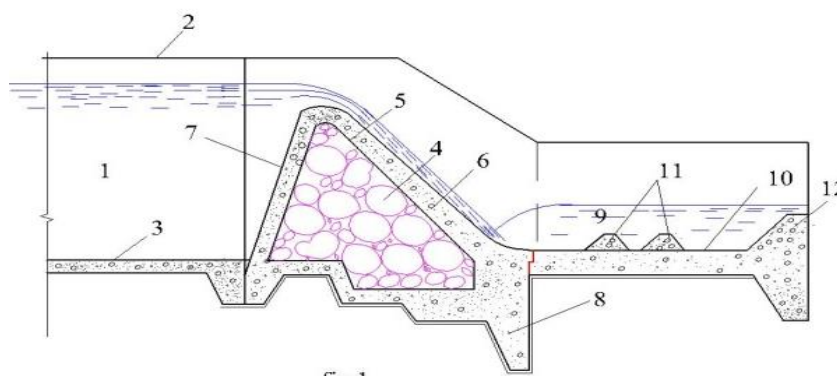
Поперечный разрез автоматической водосливной плотины сооружения: Подводящий канал-1, направляющая стенка – 2, понур-3, речные камни-4, водосливной части-5, железобетонная плита - 6, наклонная железобетонная плита - 7, бетонный зуб - 8, водосливный колодец -9, дно колодца - 10, гасители- 11, водобойная стенка.
